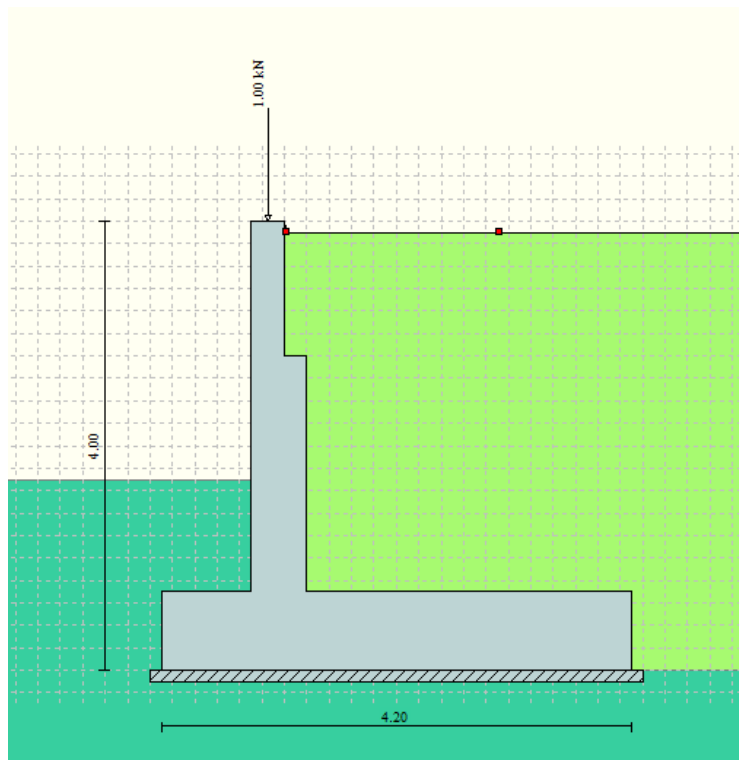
Applicazione dei carichi: Peso parapetto
